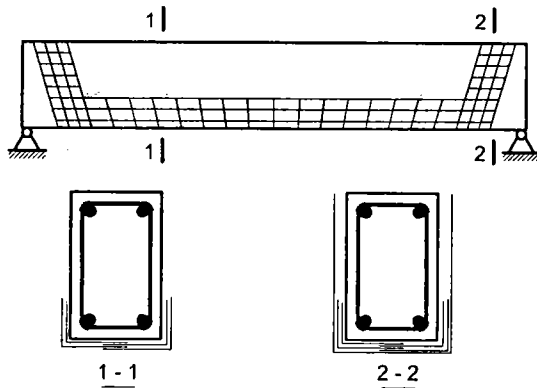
Gia cố cấu kiện chịu uốn bằng thép tấm
